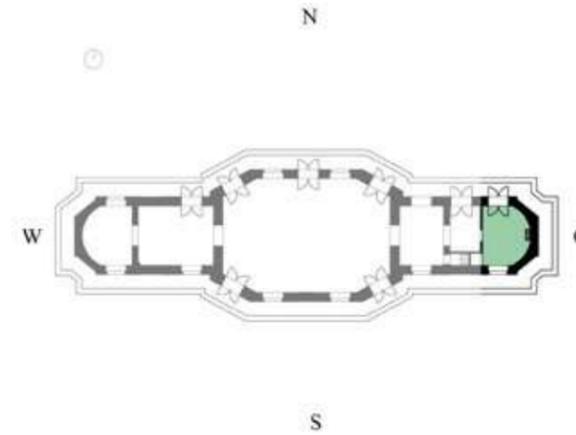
Lage im Grundriss, Gesamteindruck des Nebenflügels
